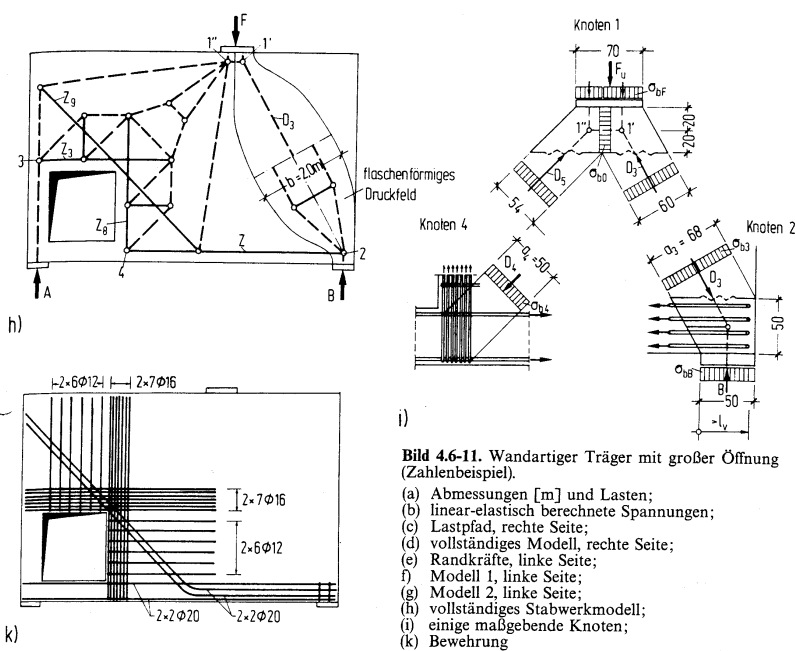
Wandartiger Träger mit großer Öffnung (Zahlenbeispiel).
